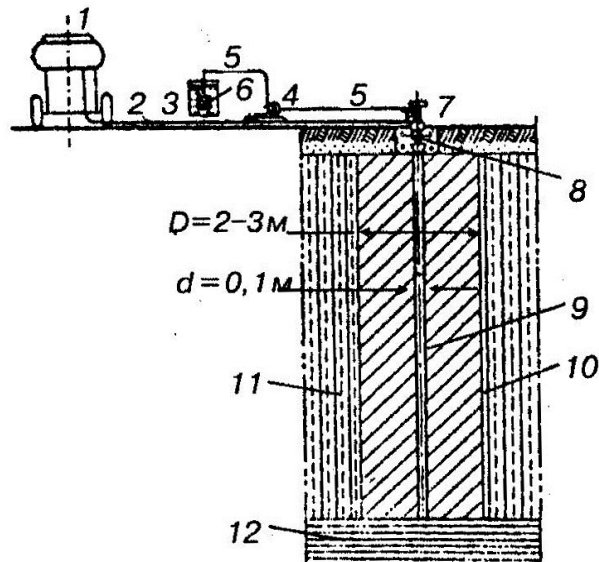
Схема установки для термічного закріплення просідного лесового ґрунту: 1 – компресор; 2 – трубопровід для холодного повітря; 3 – резервуар для рідкого палива; 4 – насос для подачі палива до свердловини; 5 – трубопровід для палива; 6 – фільтр; 7 – форсунка; 8 – затвор з камерою згоряння; 9 – свердловина; 10 – зона термічного закріплення; 11 – просідний ґрунт; 12 – непросідний ґрунт
